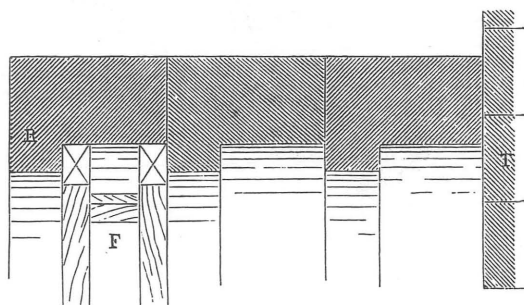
Galería subterránea en las termas de Hierápolis. Sección longitudinal de la bóveda
